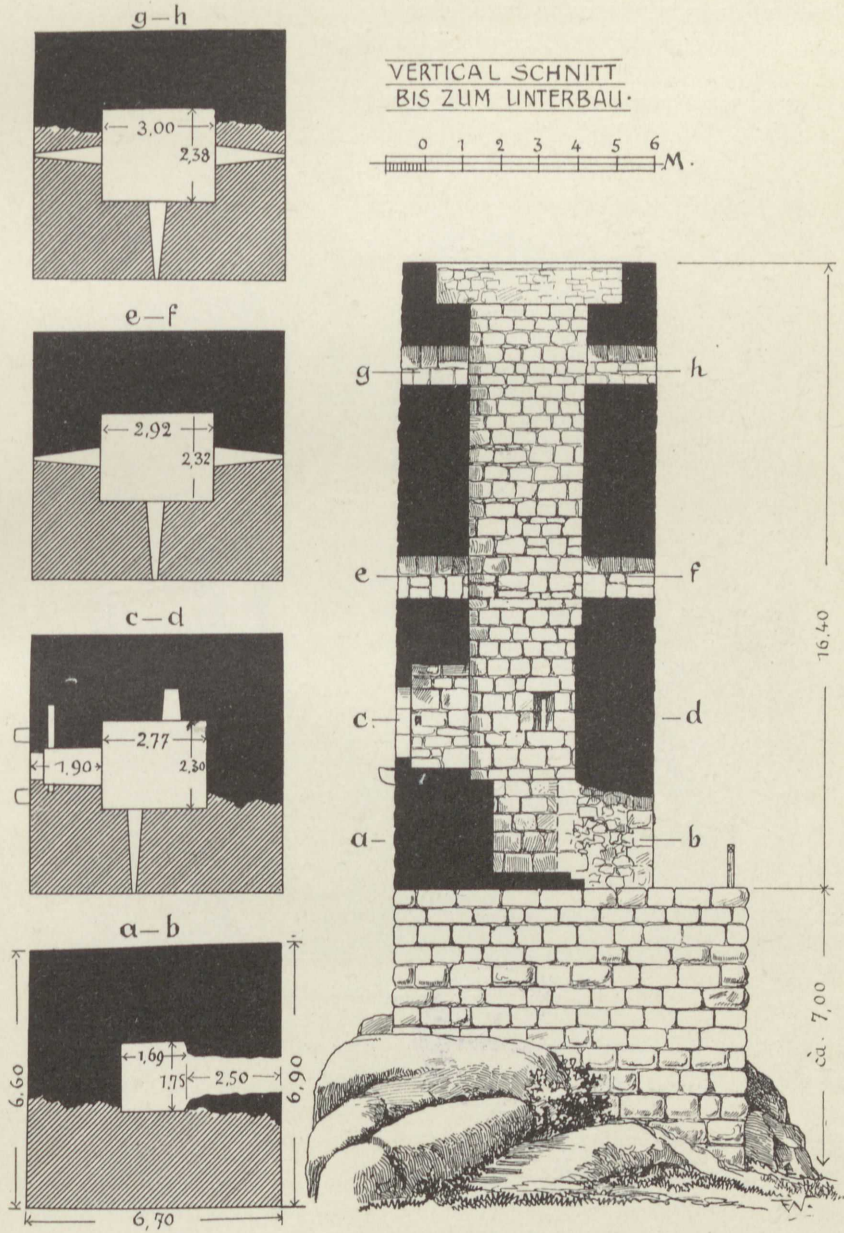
Leuchtenberg. Grundrisse und Schnitt des Bergfrieds.
